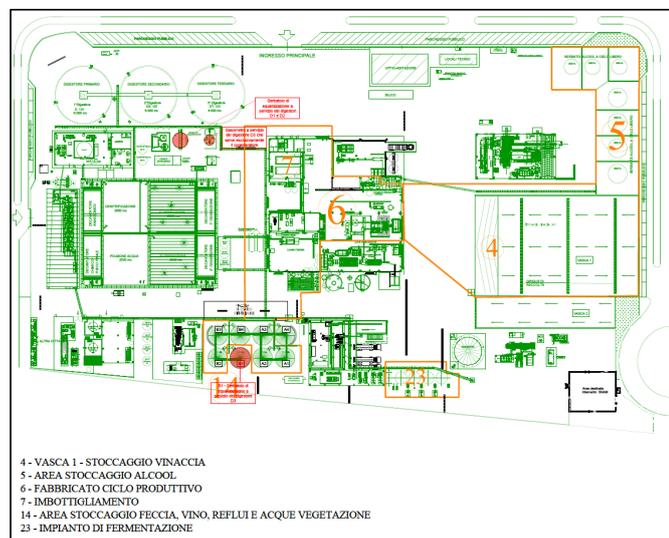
planimetria della sezione DISTILLERIA E FERMENTAZIONE
